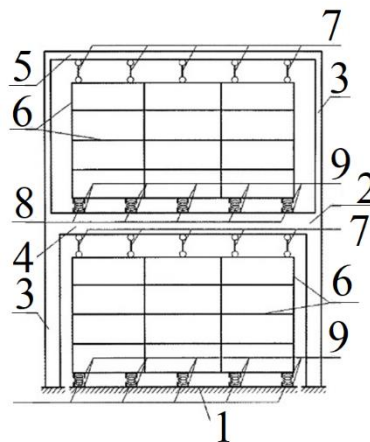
Ветроустойчивое, сейсмостойкое подвешеное здание с подпружиниванием: 1 – фундамент; 2 – рамная конструкция; 3 – колонны; 4, 5 – ригели; 6 – этажные объёмы здания; 7 – подвески; 8 – упругие опоры; 9 – патрубки
